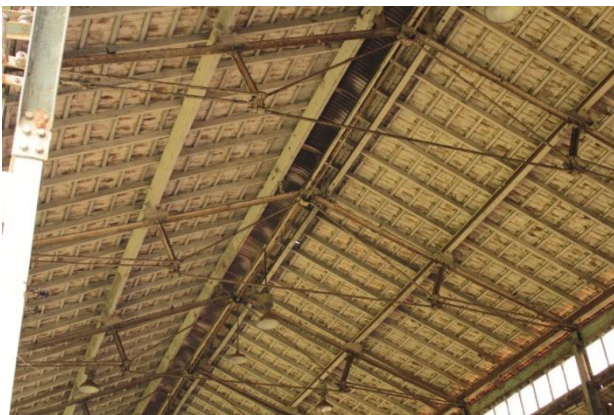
176: Ligação viga e pilar - Elétrica
